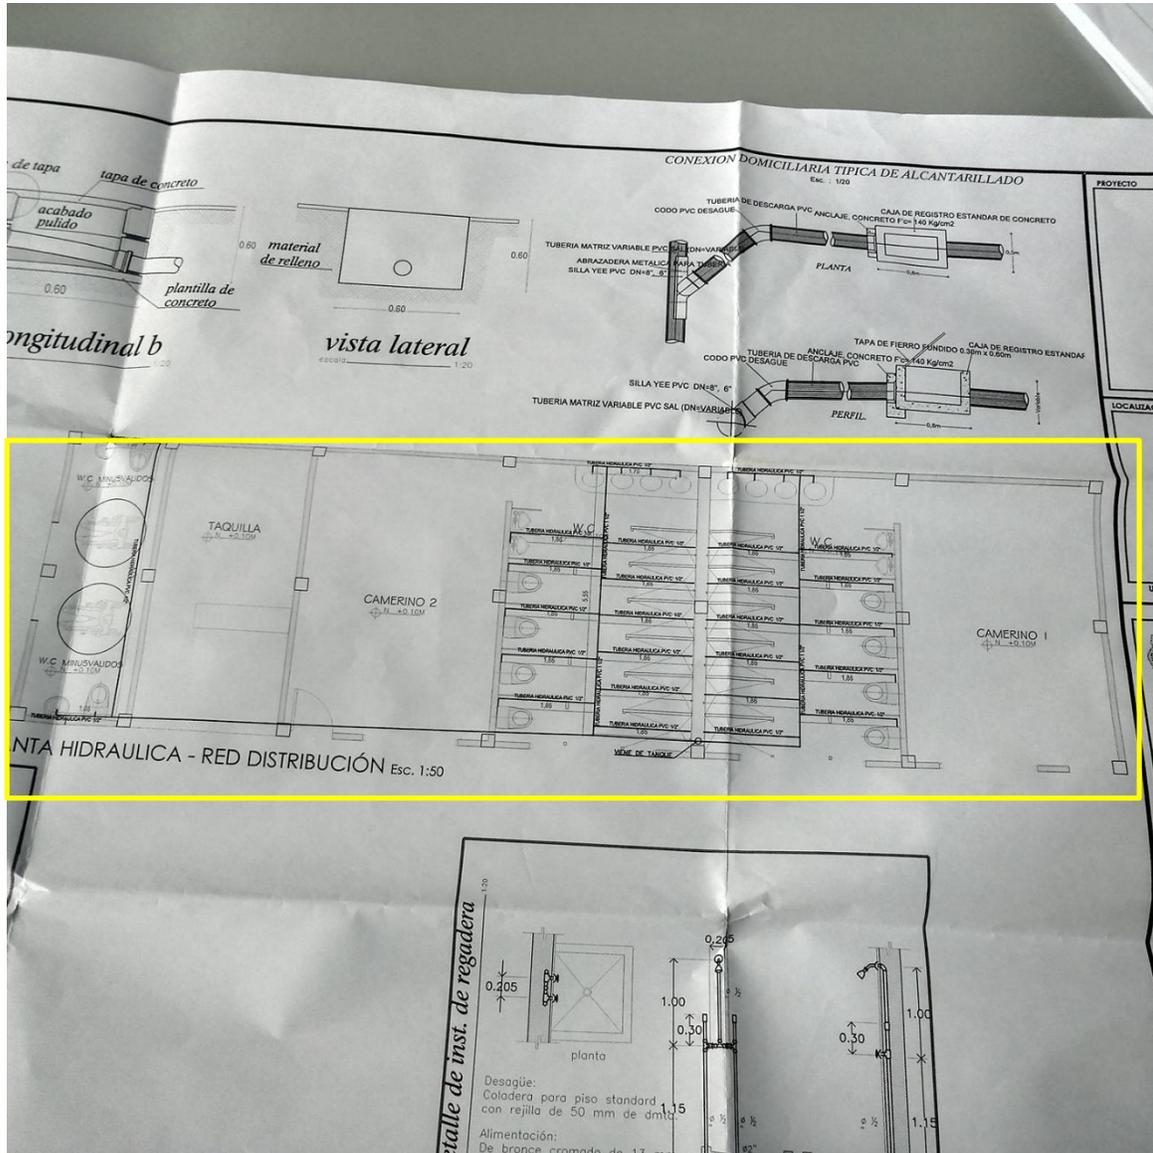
Planta arquitectónica, zona de camerinos, plano 4 de 5, planta hidráulica, red de distribución. Convenio 1297/17, Menegua.
